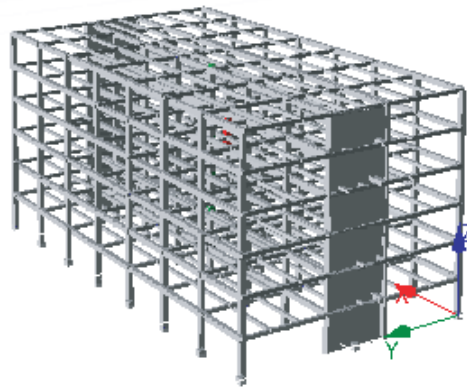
Bâtiment B6 avec les colonnes et les poutres
